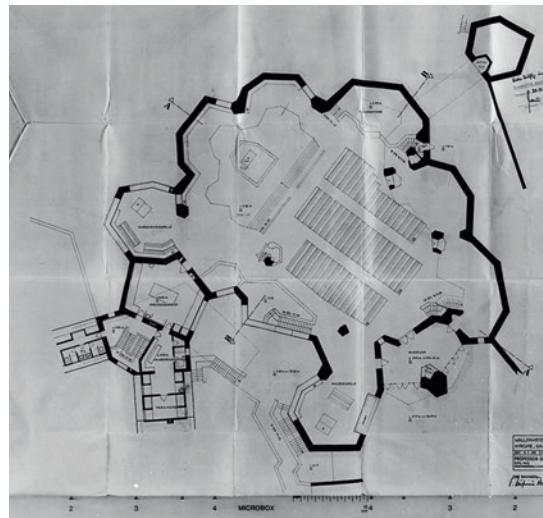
Grundriss der Wallfahrtskirche, Gottfried Böhm, 1965 (Plan: LVR-Amt für Denkmalpflege im Rheinland, Gottfried Böhm)
